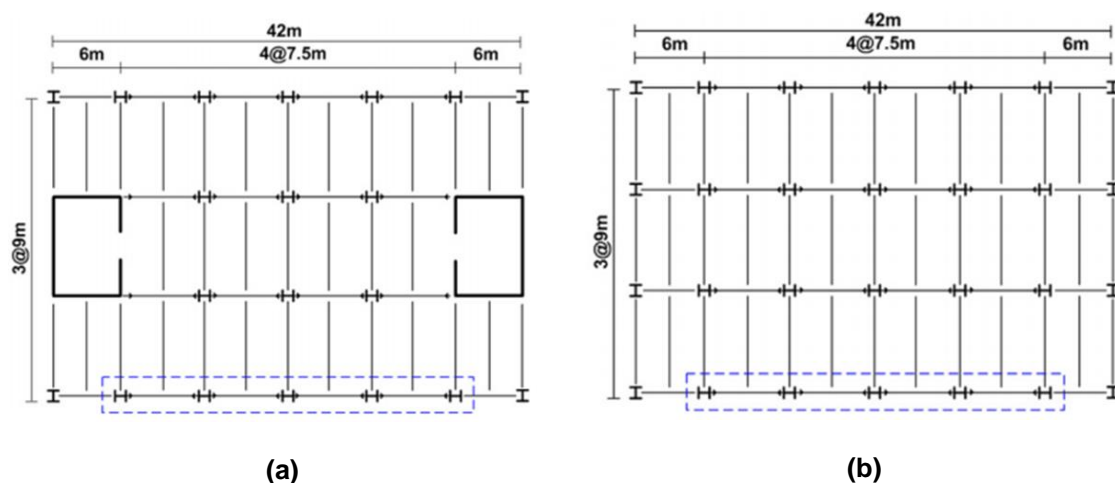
Planta estrutural (a) Sistema GLRS; (b) Sistema LLRS (adaptado de [17])
